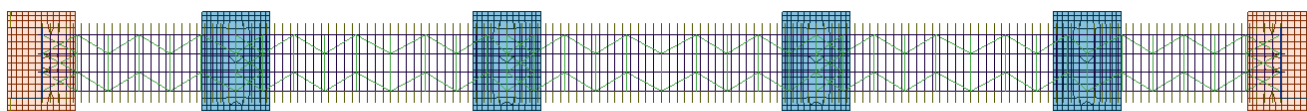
Modellazione tridimensionale Elementi finiti – pianta
